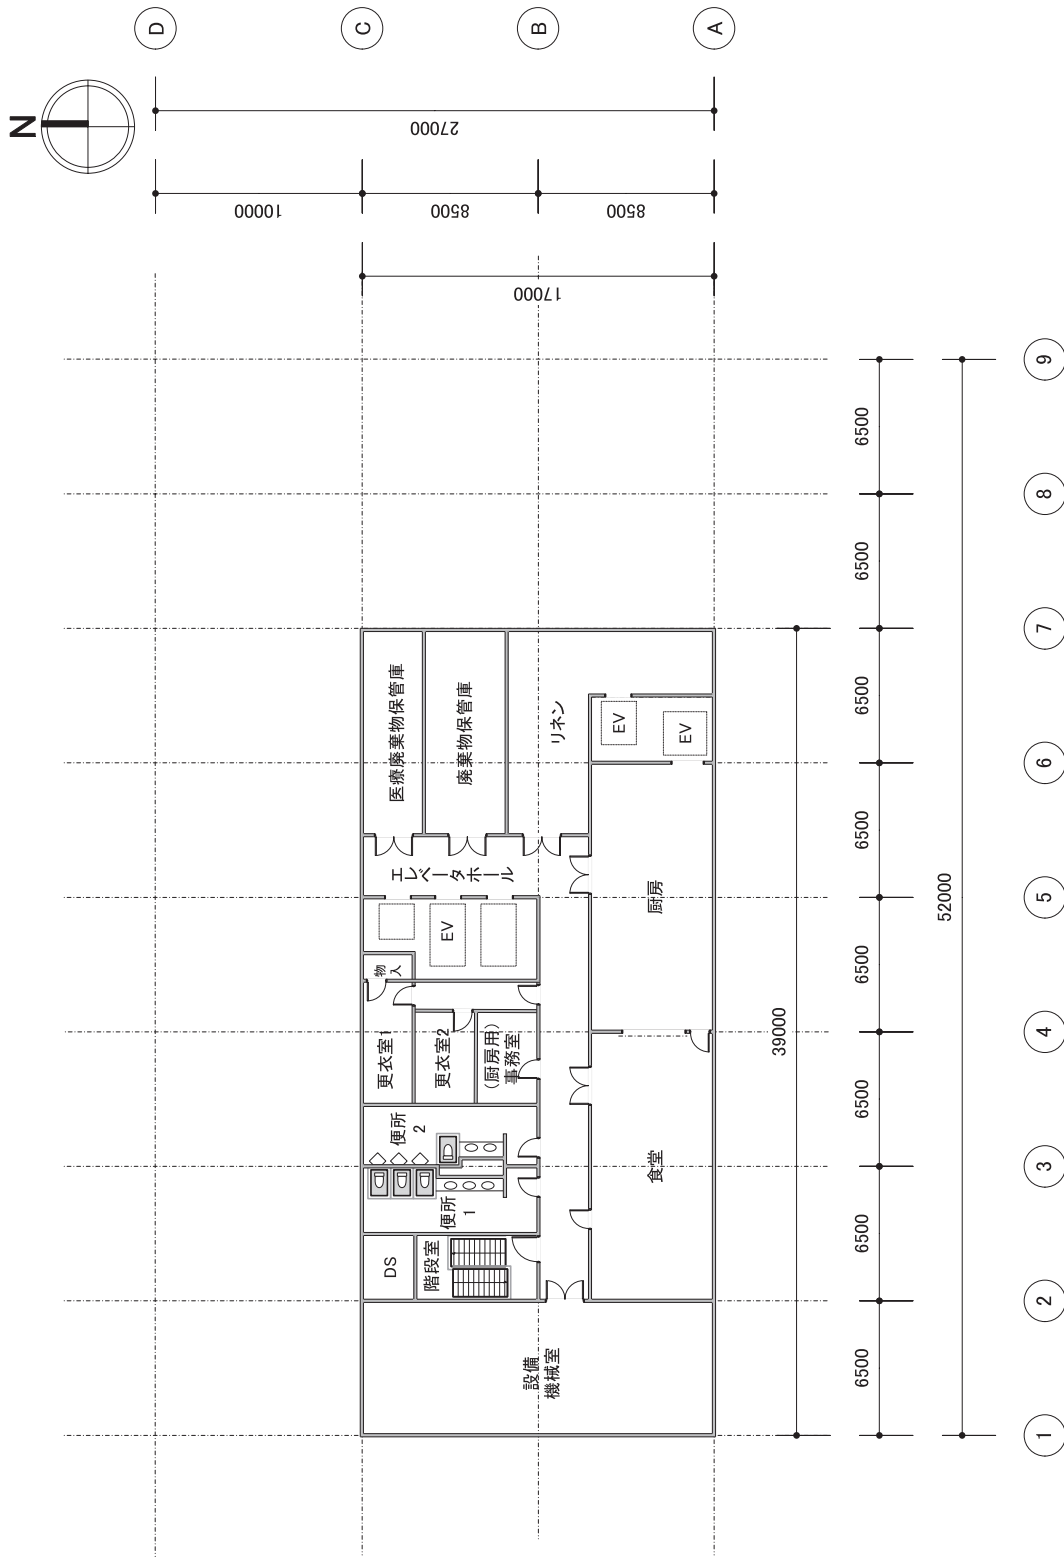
モデル建物 (病院等、5,000m²) 地下1階平面図
